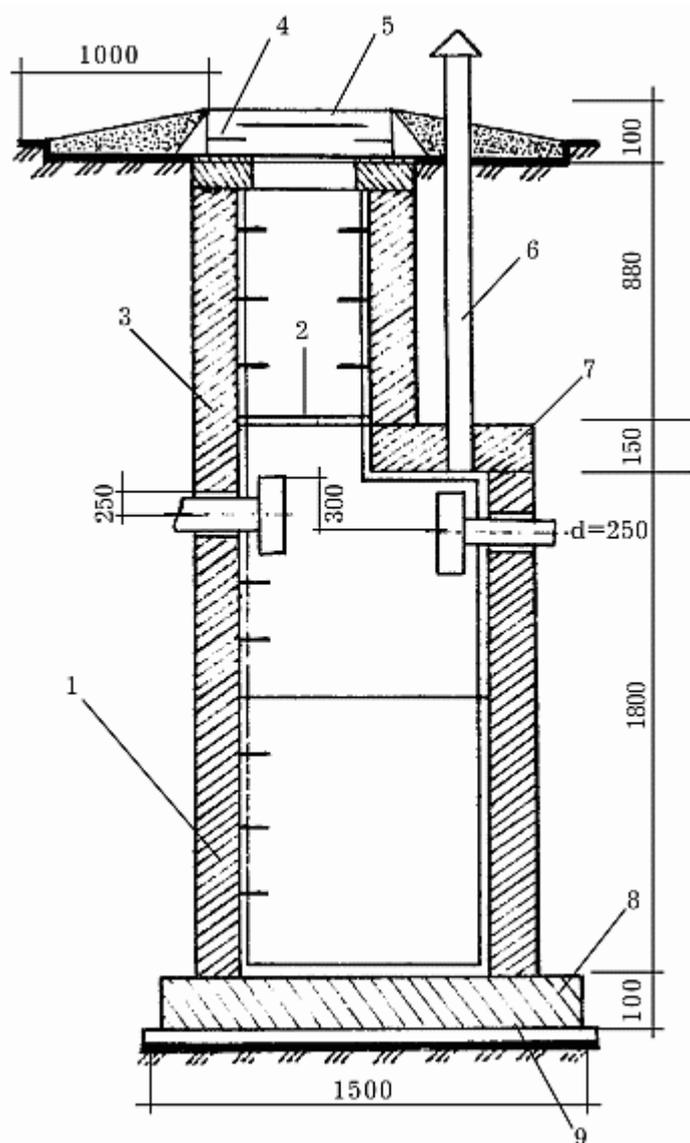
Септик из сборных железобетонных элементов: 1 – железобетонное кольцо; 2 – деревянная крышка; 3 – железобетонное кольцо; 4 – опорное железобетонное кольцо; 5 – чугунный люк или деревянная крышка; 6 – вентиляционный стояк; 7 – железобетонная плита перекрытия; 8 – железобетонная плита днища; 9 – цементная стяжка (размеры даны в мм).
